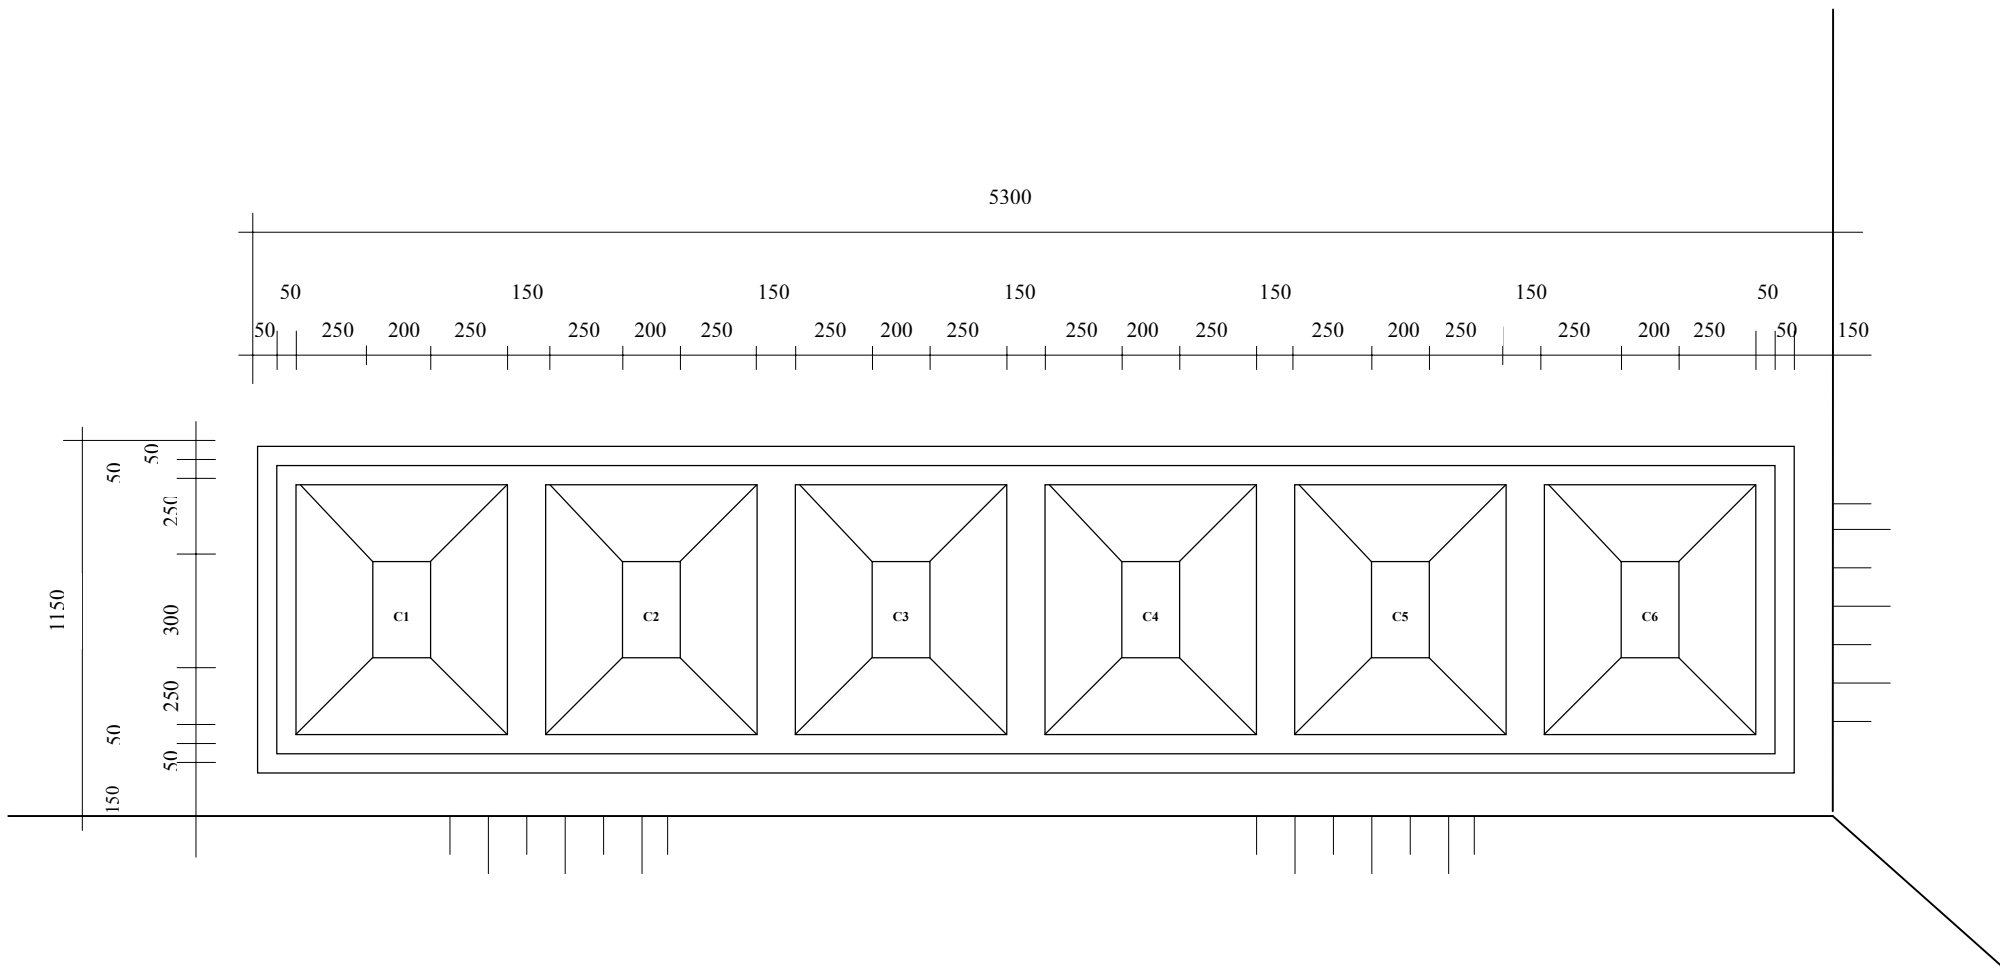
Planta de localização da escavação das células sobre a *Célula 4* do Aterro Sanitário Zona Norte.
